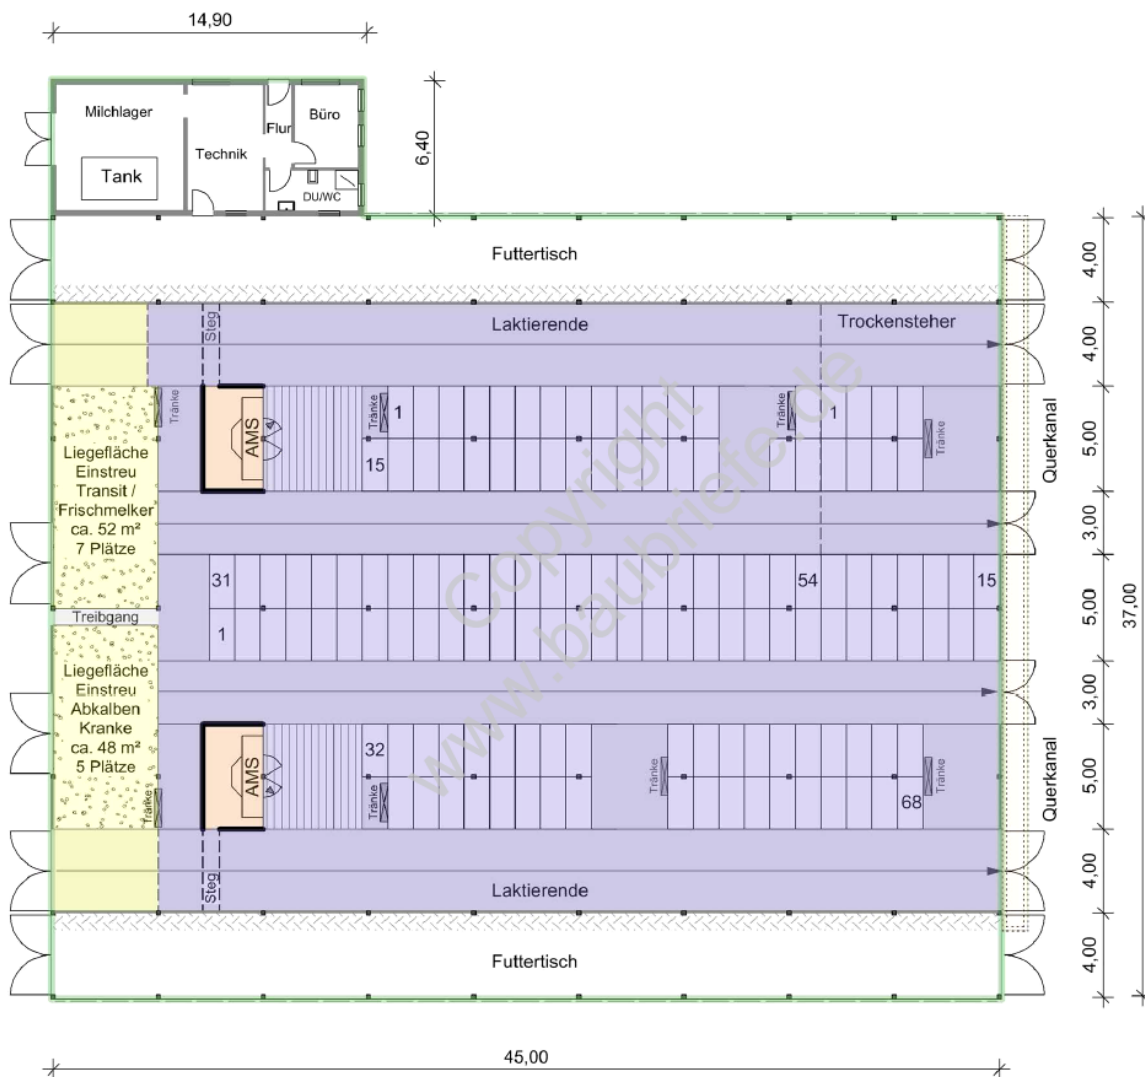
Grundriss für einen Liegeboxenlaufstall mit 2 Melkrobotern
